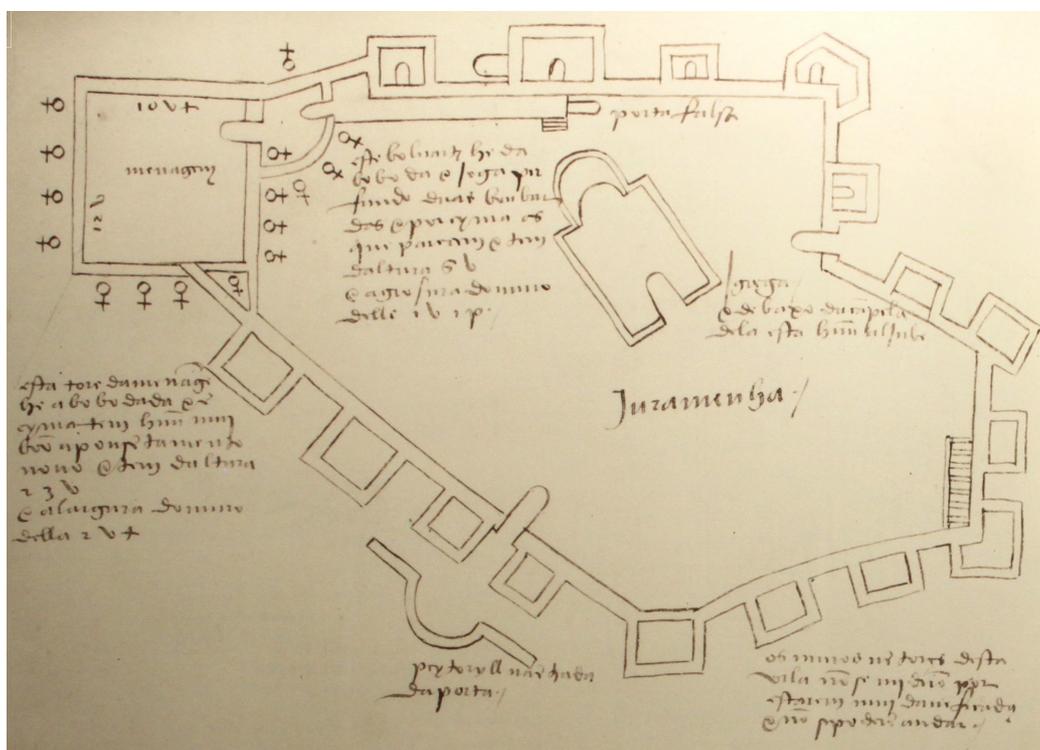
Planta do castelo de Juromenha executada por Duarte de Armas, em 1509
